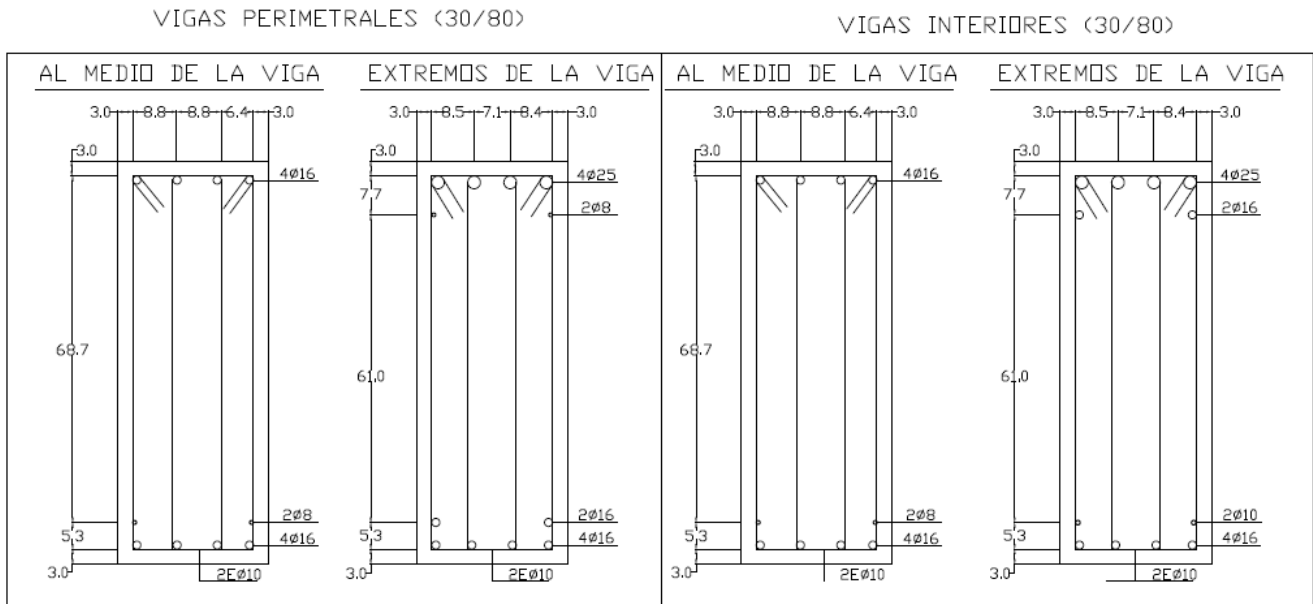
Sección transversal de las vigas en el nivel de aislación
